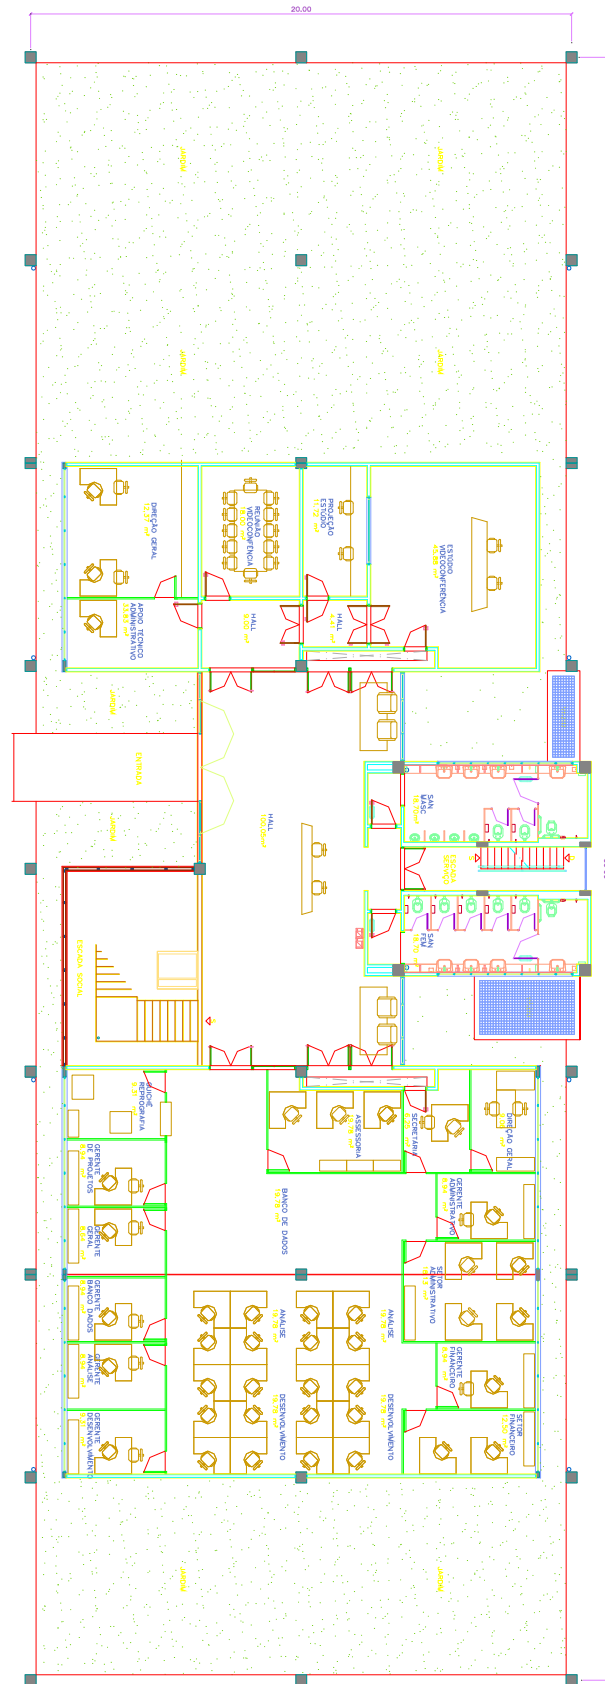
Planta baixa do pavimento térreo do prédio do NTI
